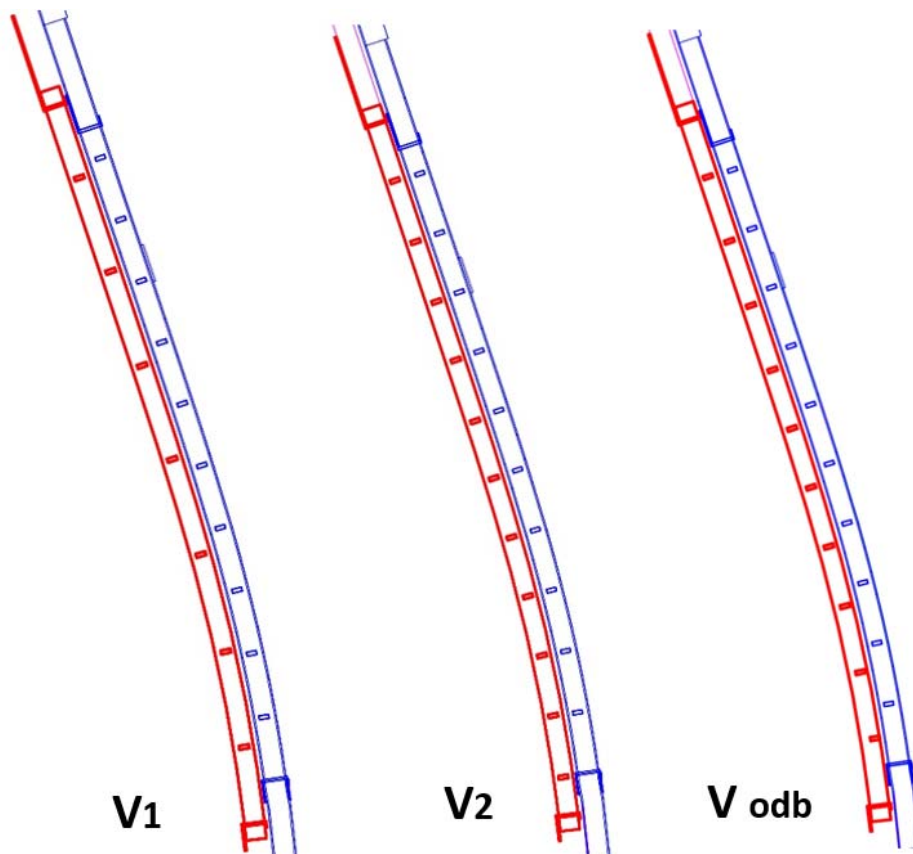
Prikaz pogleda na vijadukt Ravninščica – varijanta 2 (plavo – postojeći, crveno – planirani)
